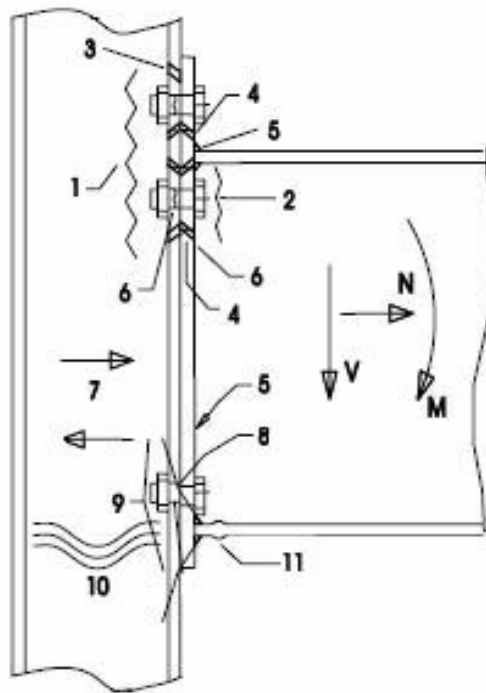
Pontos de análise da ligação [3]: 1 - alma do pilar à tracção; 2 - alma da viga à tracção; 3 - banzo do pilar à flexão; 4 - chapa de topo à flexão; 5 - soldaduras à tracção; 6 - parafusos à tracção; 7 - alma do pilar ao corte; 8 - parafusos ao corte; 9 - alma do pilar à compressão; 10 - encurvadura da alma do pilar; 11 - banzo inferior da viga.
